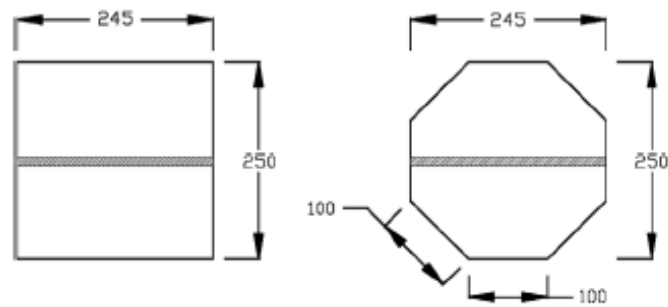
Sezioni rette dei pilastri testati [3.104]
